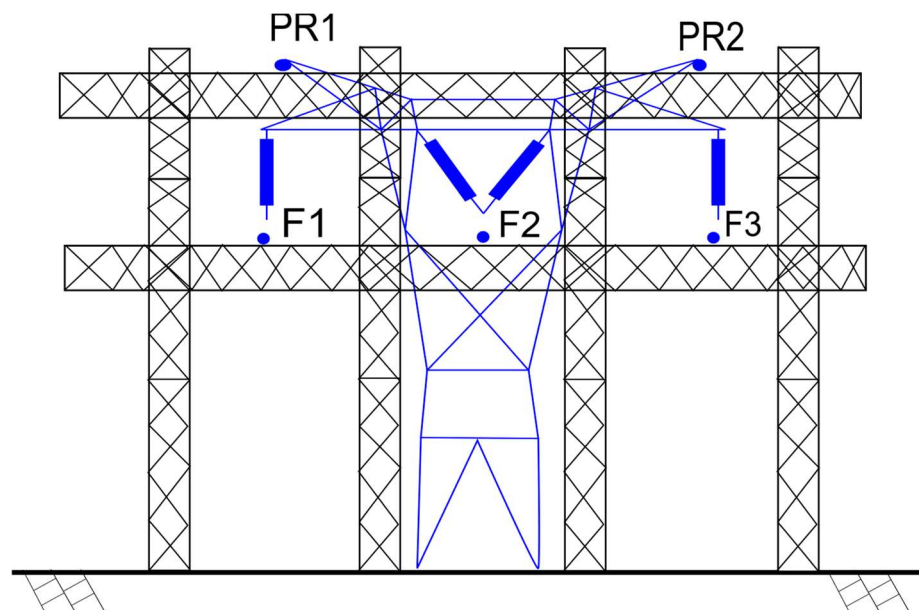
Vista lateral do pórtico auxiliar de desmontagem.
